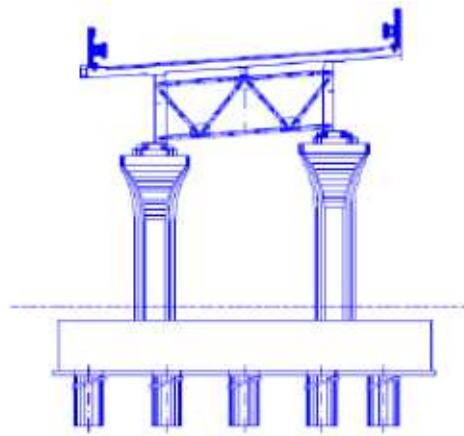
Proposta di variante, sezione trasversale tipologica pile
